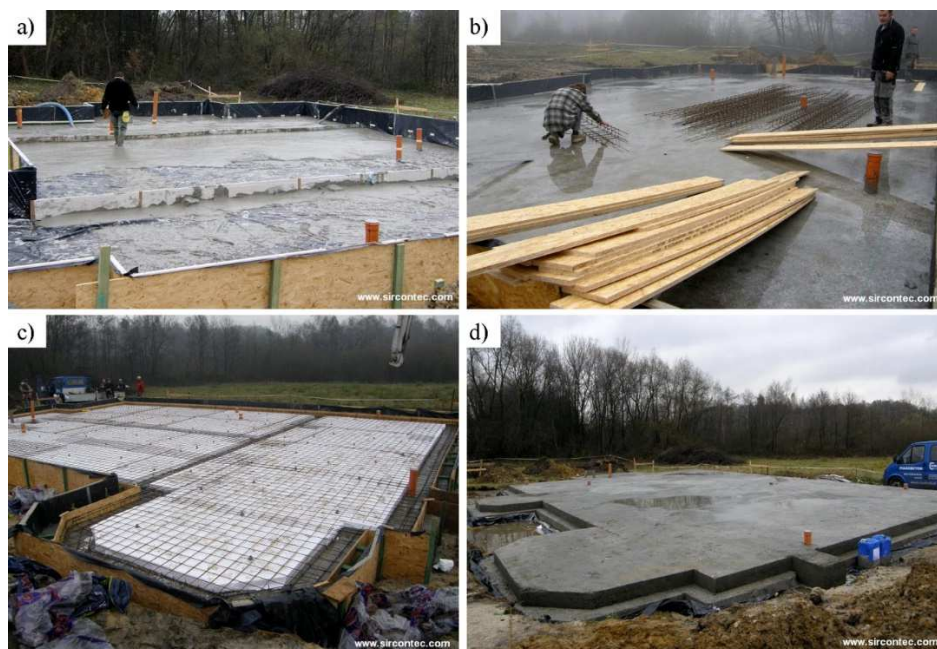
Konstrukcja fundamentowej płyty pianobetonowej
